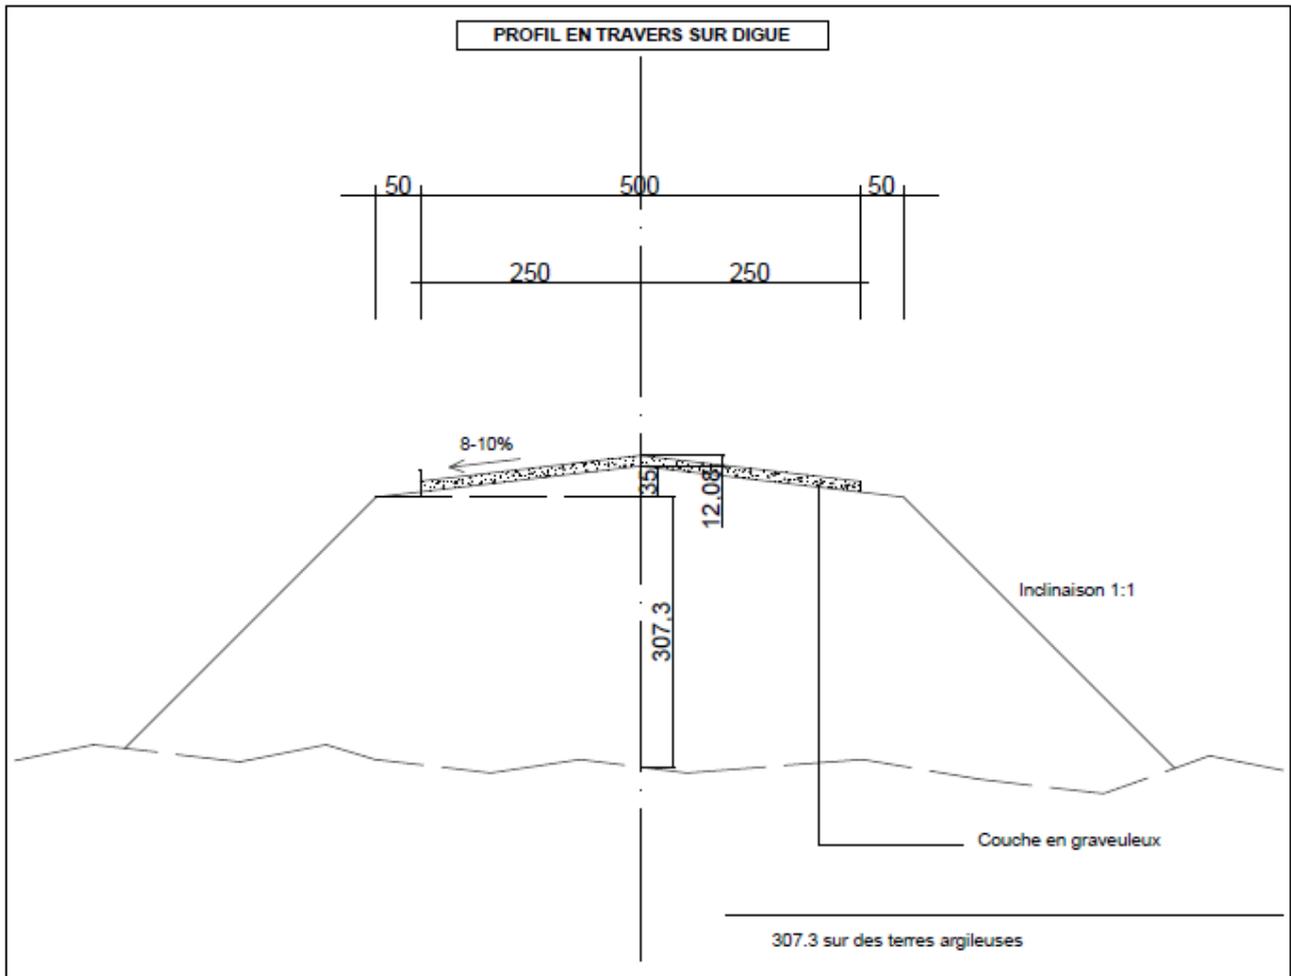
PROFIL EN TRAVERS DE TYPE C (PROFIL SUR DIGUE)
